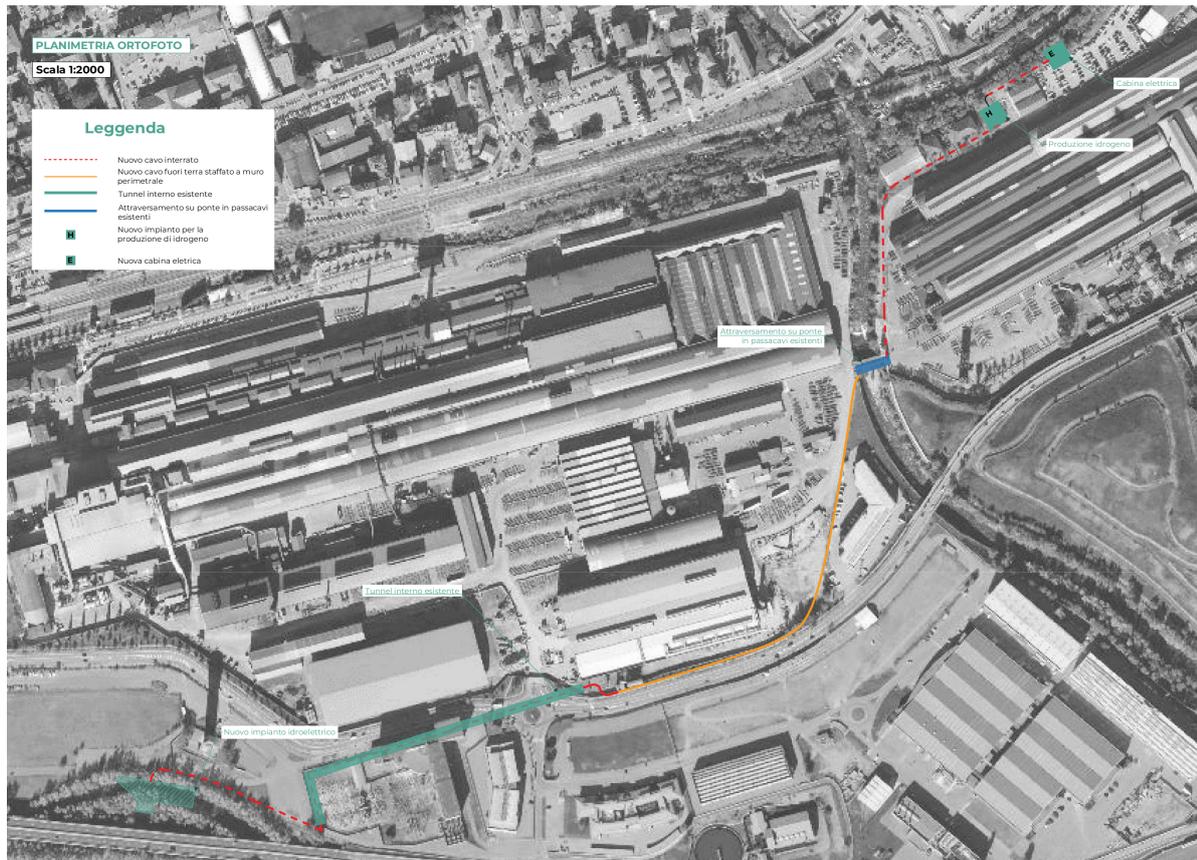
Planimetria tracciato cavidotto di alimentazione dell'elettrolizzatore.
